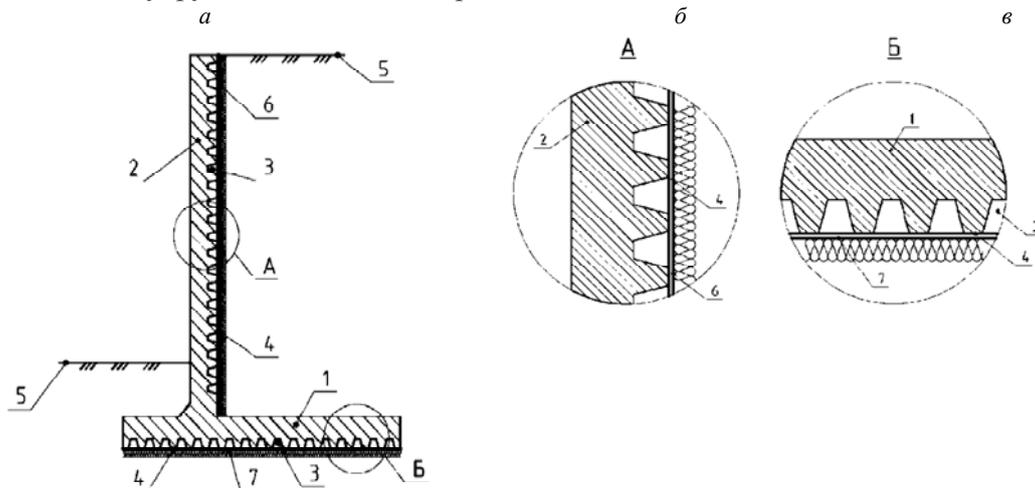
Монолитная подпорная стена специального типа: а – поперечный разрез; б – узел А; в – узел В;
